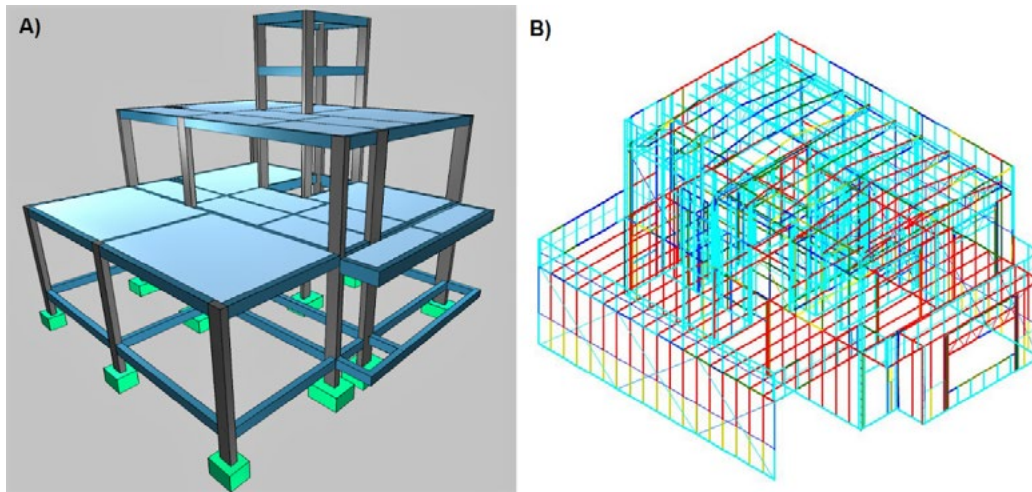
a) Estrutura em concreto armado e b) estrutura LSF
